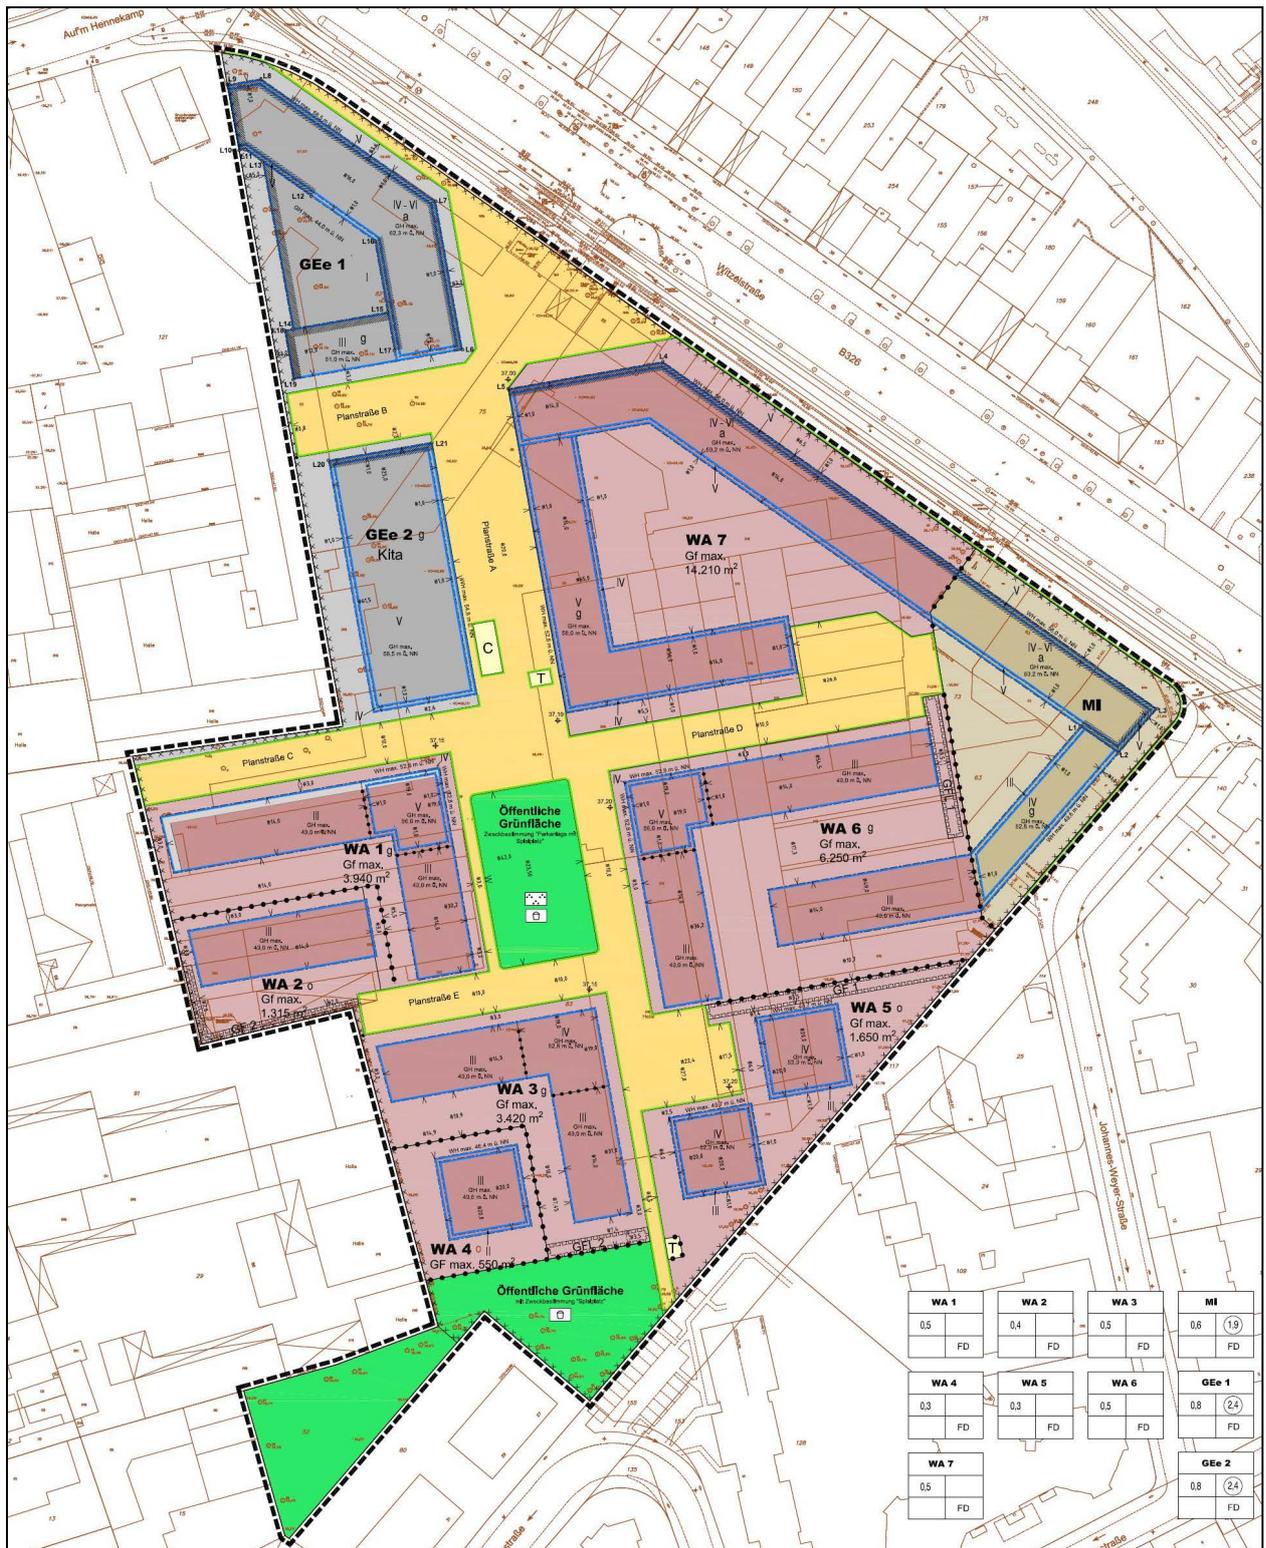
Bauungsplan Nr. 03/003 (Stand: November 2016)
